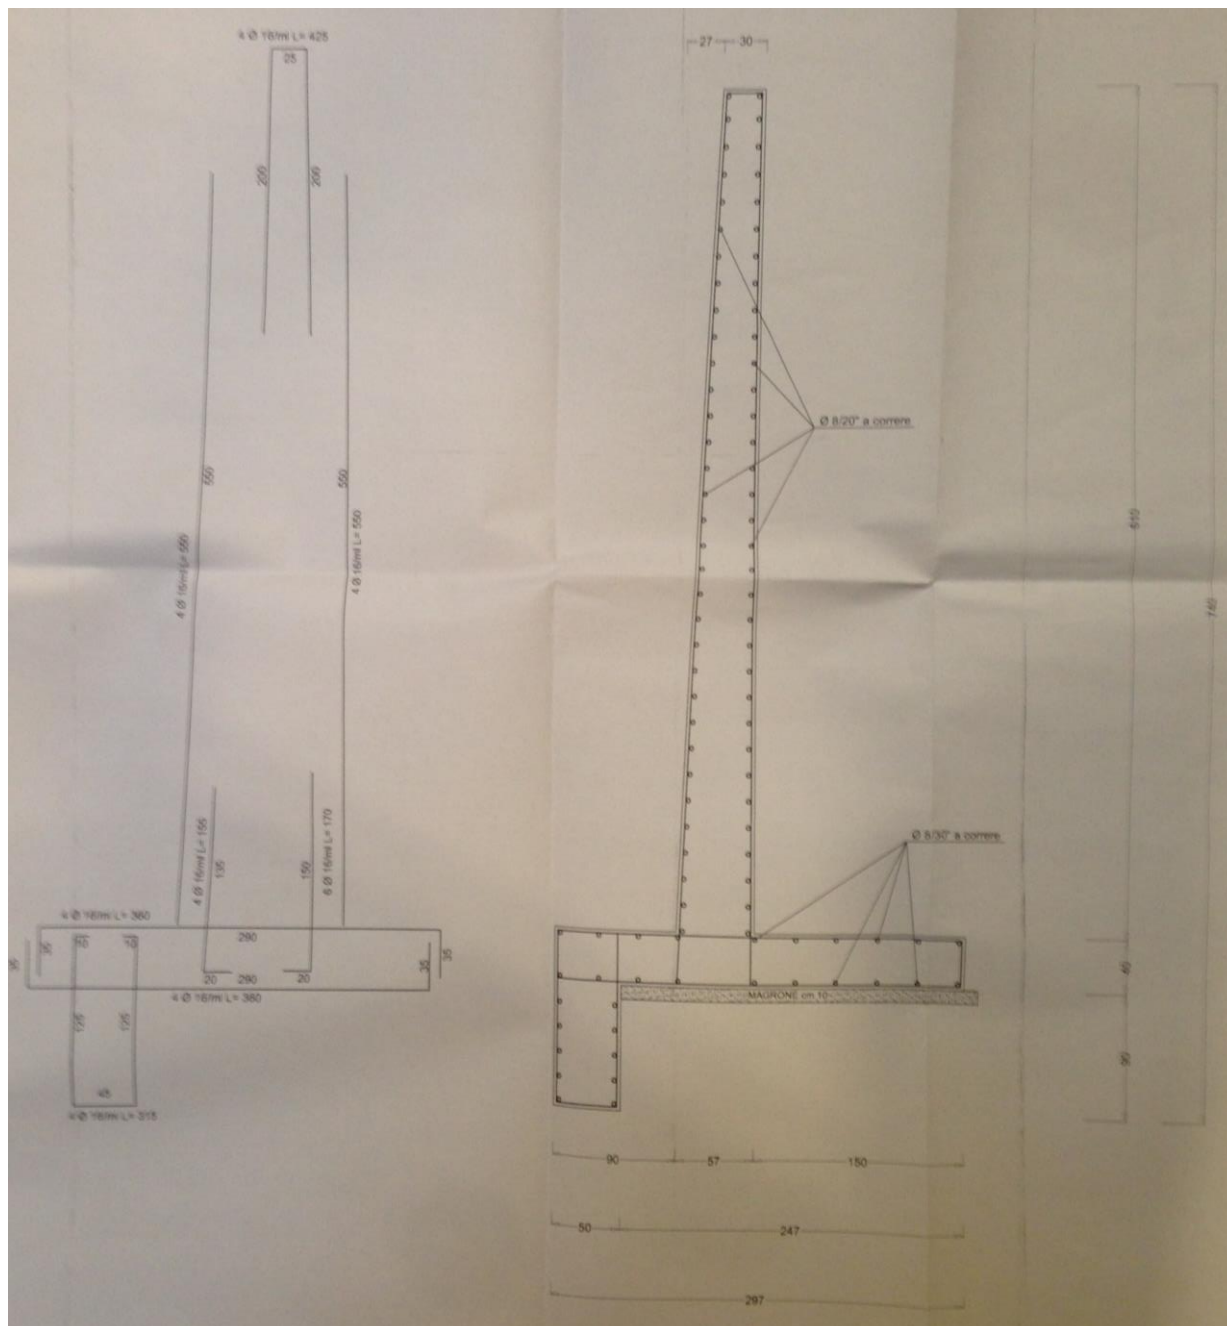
Sezione muro in c.a. – Estratto Pratica Sismica N. 373/2009
